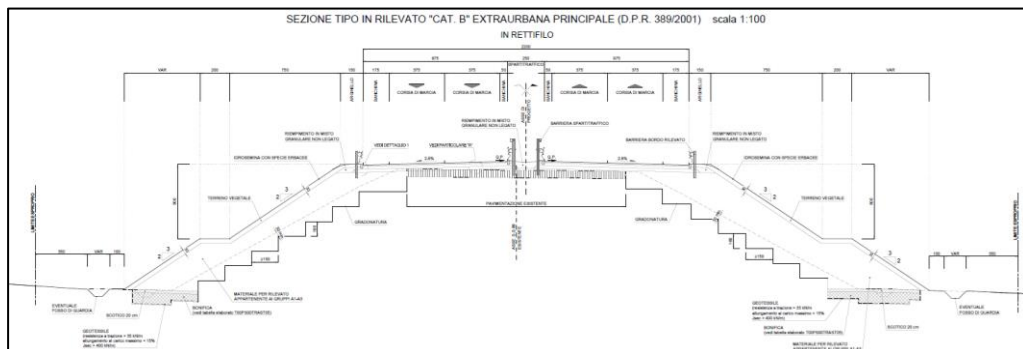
Sezione tipo asse principale, rilevato, rettilineo. (stralcio elaborato T00PS00TRAST01A allegato al Progetto Definitivo)
